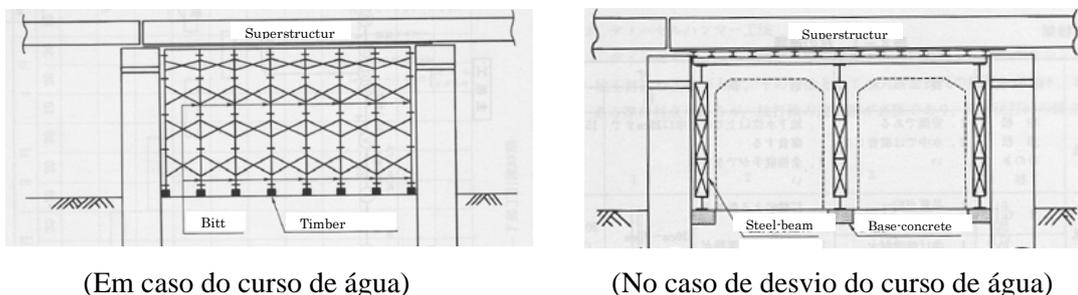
Método de Construção de Tabuleiro com Suporte para o Tipo RC Hollow Slab
